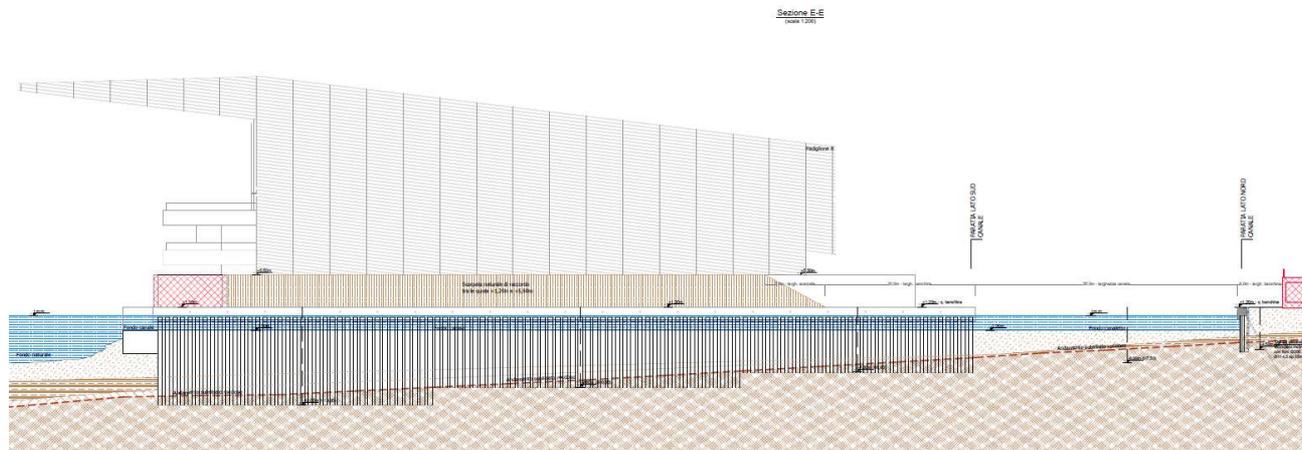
Sezioni longitudinali - Andamento in profondità delle paratie (stralcio tavola 04-D-St del Progetto Definitivo).
